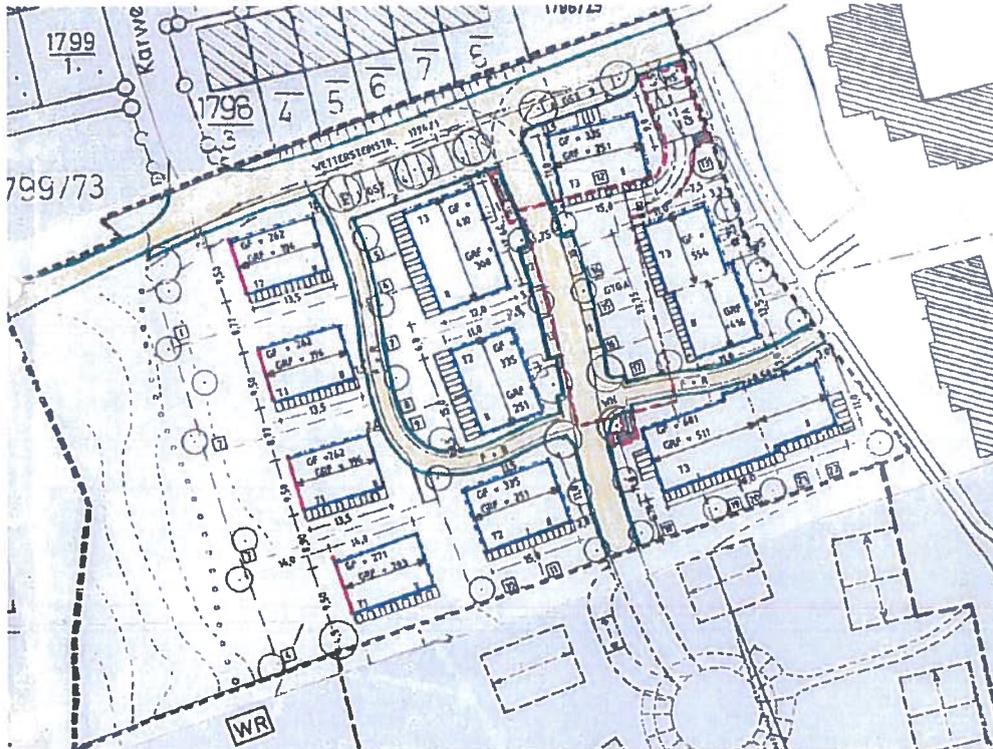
Planzeichnung des rechtswirksamen Bebauungsplans i.d.F. vom 25.06.1996, ohne Maßstab
